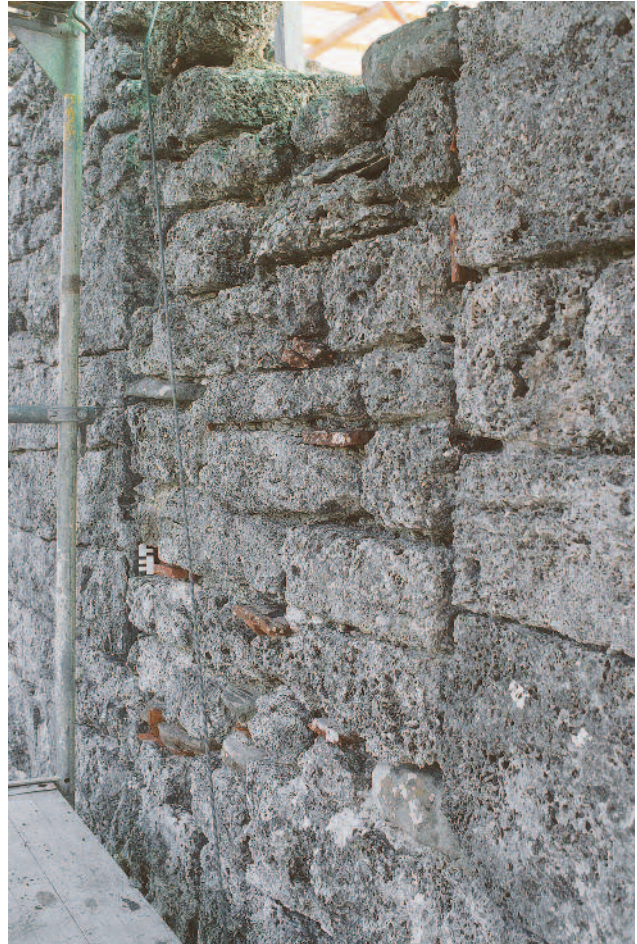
Kastelen LU. Westfassade, 4. Obergeschoss. Zugemauerte Rundbogenöffnung Pos. 4501. Blick von Südwesten.
